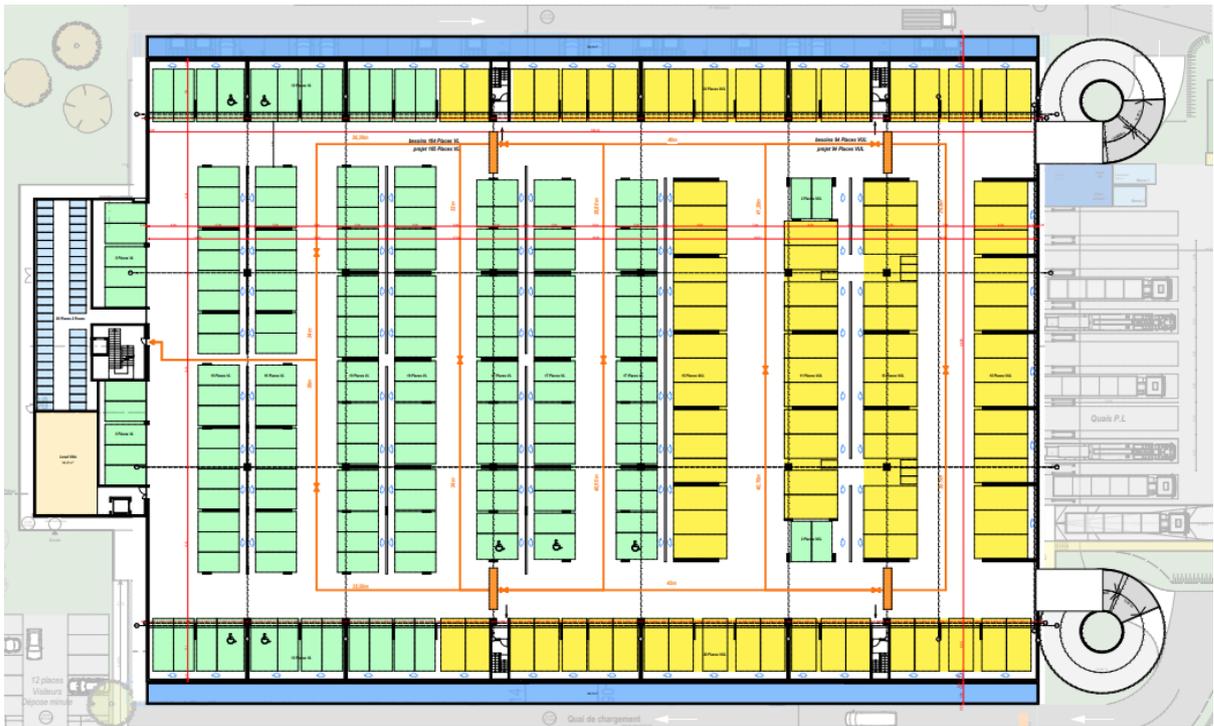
PLAN DU SOUS-SOL (SOURCE : ABC ARCHITECTES)
